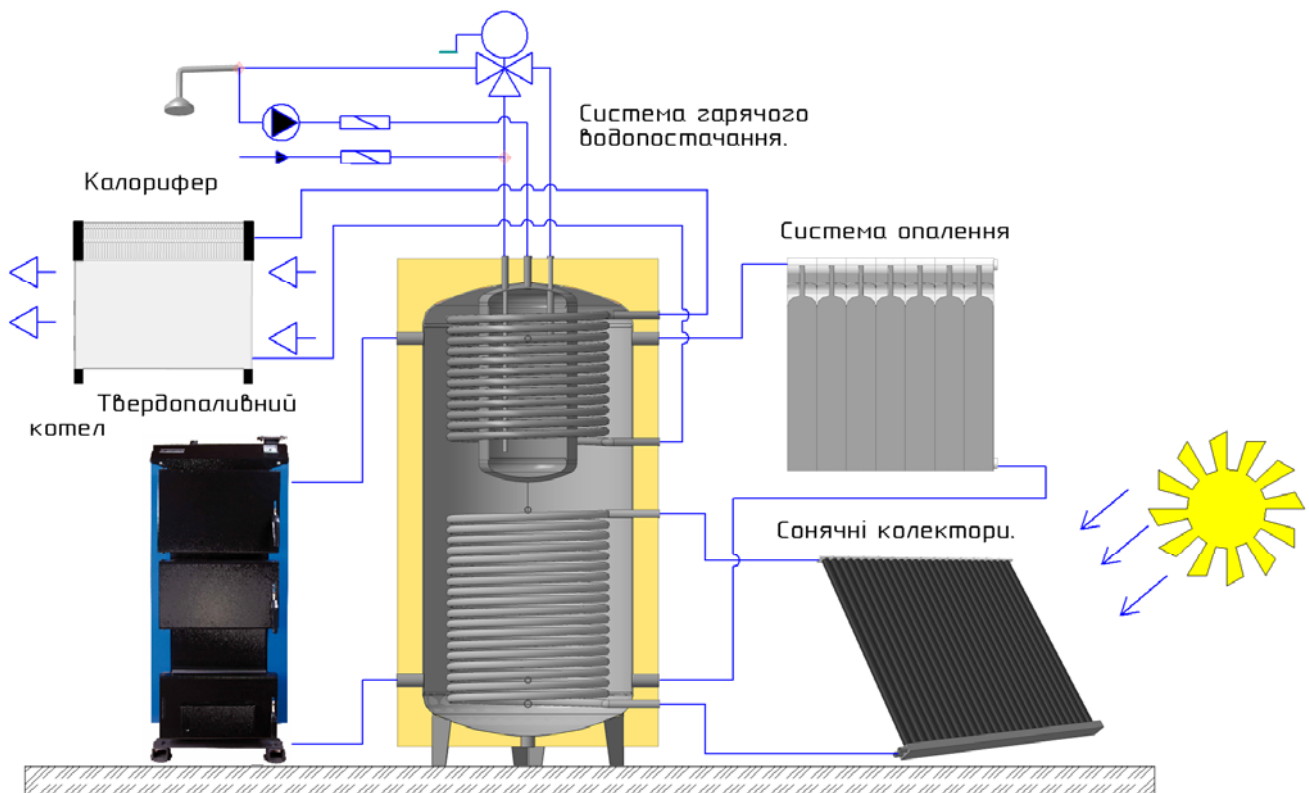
Типова схема під'єднання твердопаливного котла та бака
